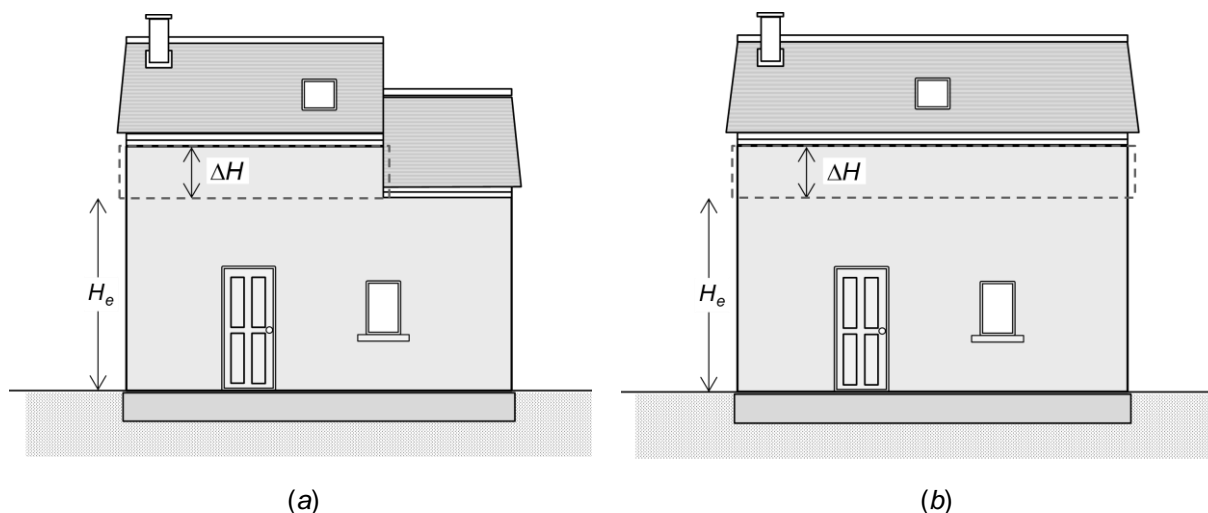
exemple de la surélévation (a) partielle et (b) entière d'une toiture
